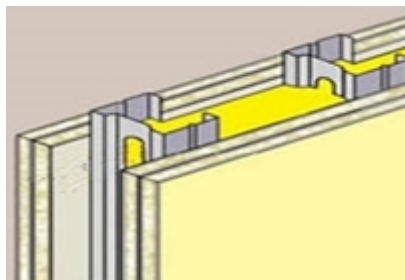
Detalle pladur. (Fuente: escayolistasvalencia)
